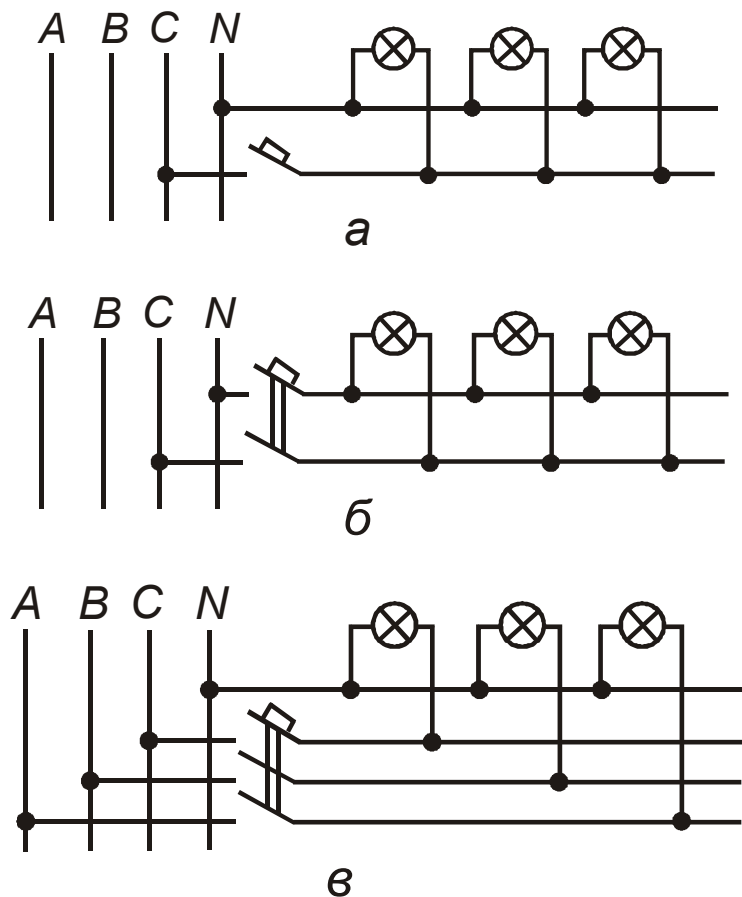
Схемы групповых линий: а – двухпроводная; б – двухпроводная для взрывоопасных помещений класса В-I; в – четырехпроводная, защищаемая трехполюсным автоматическим выключателем
